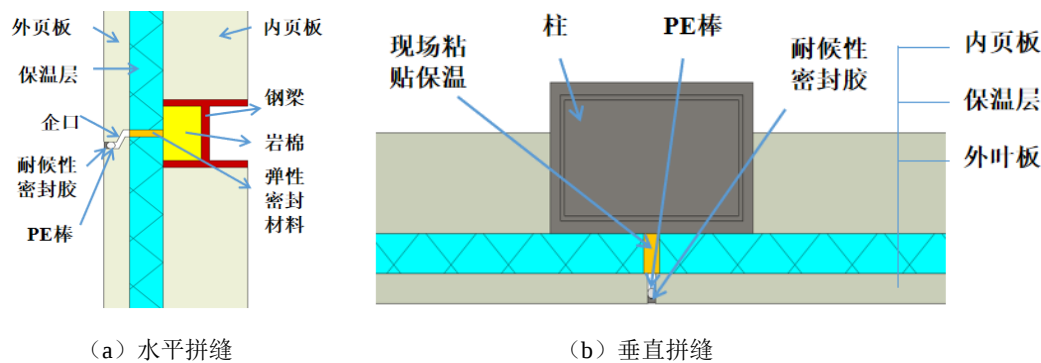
墙体与主体结构拼缝部位做法示意图
